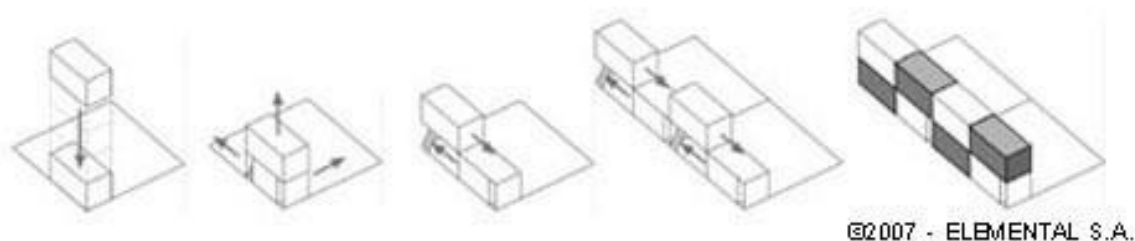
Esquema do Edifício Paralelo. (FONTE: ELEMENTAL)
